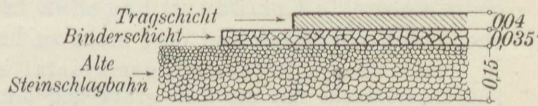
Walzasphaltpflaster auf alter Steinschlagbahn.
